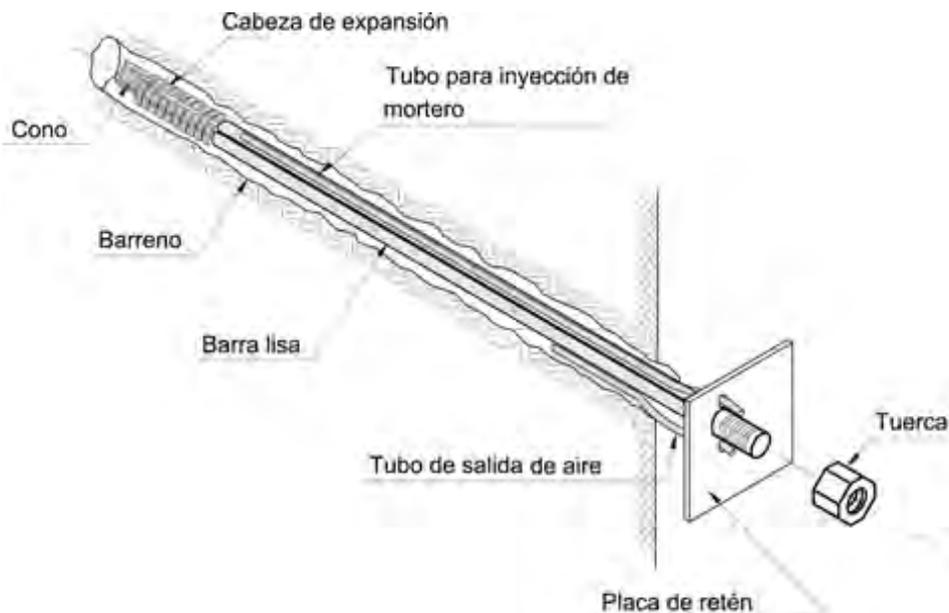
Esquema típico de anclaje mecánico expansivo.
